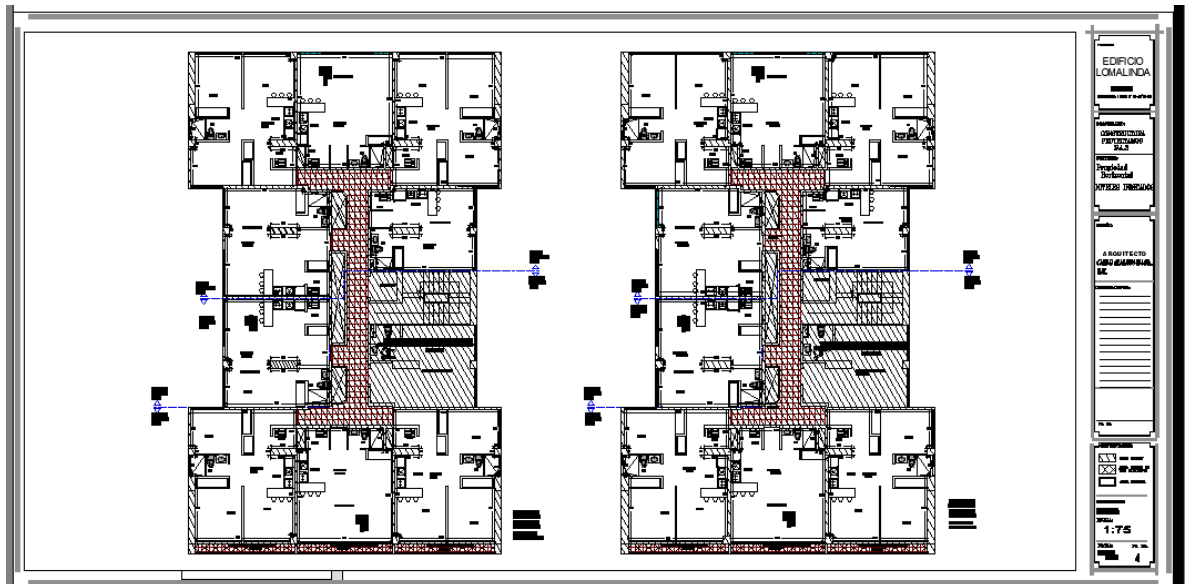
PLANO PROPIEDAD HORIZONTAL – PLANO 3.
